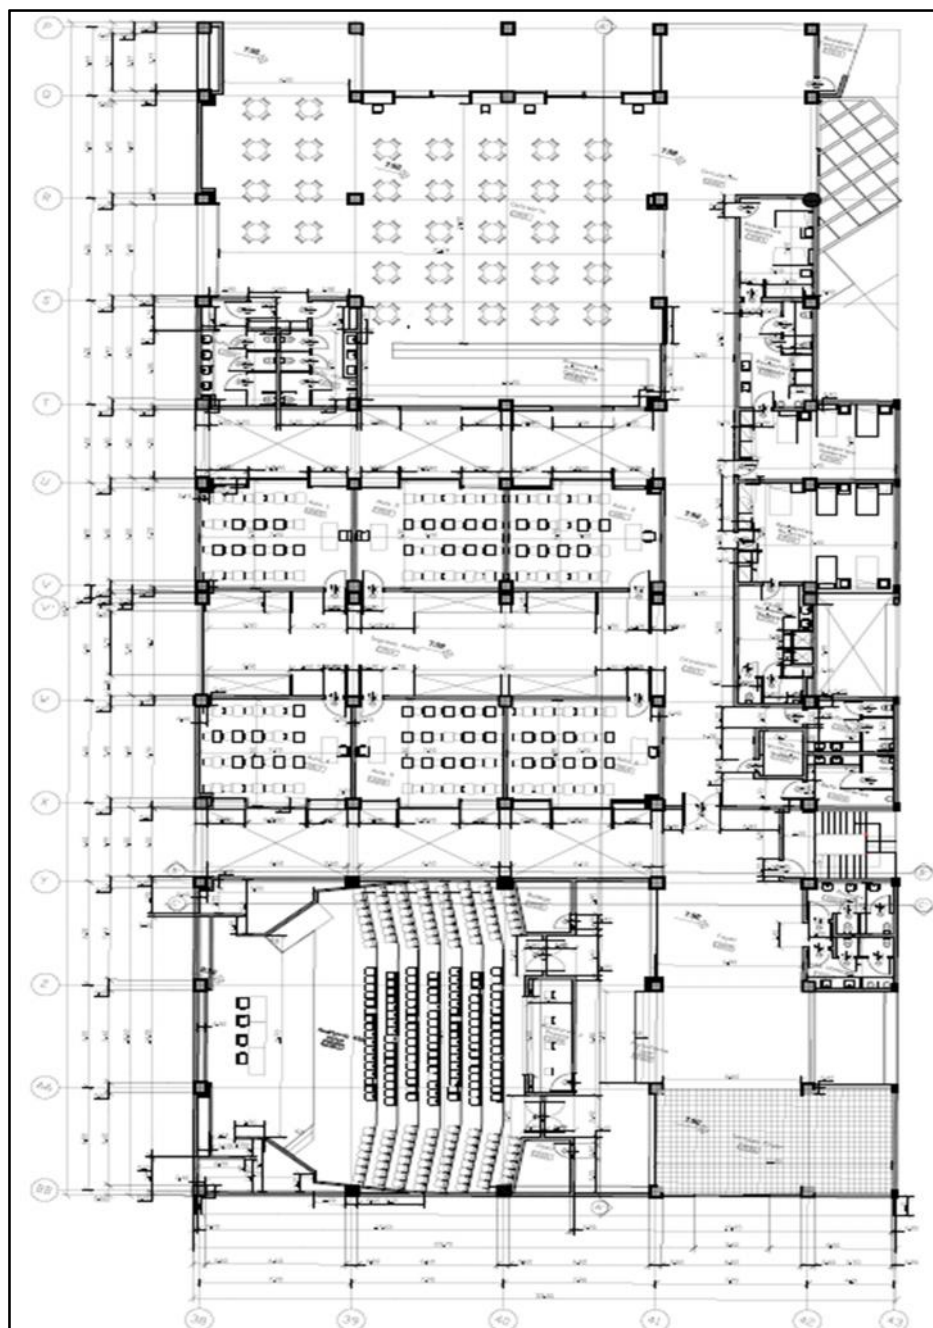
Planta arquitectónica, Consulta Externa I y II
